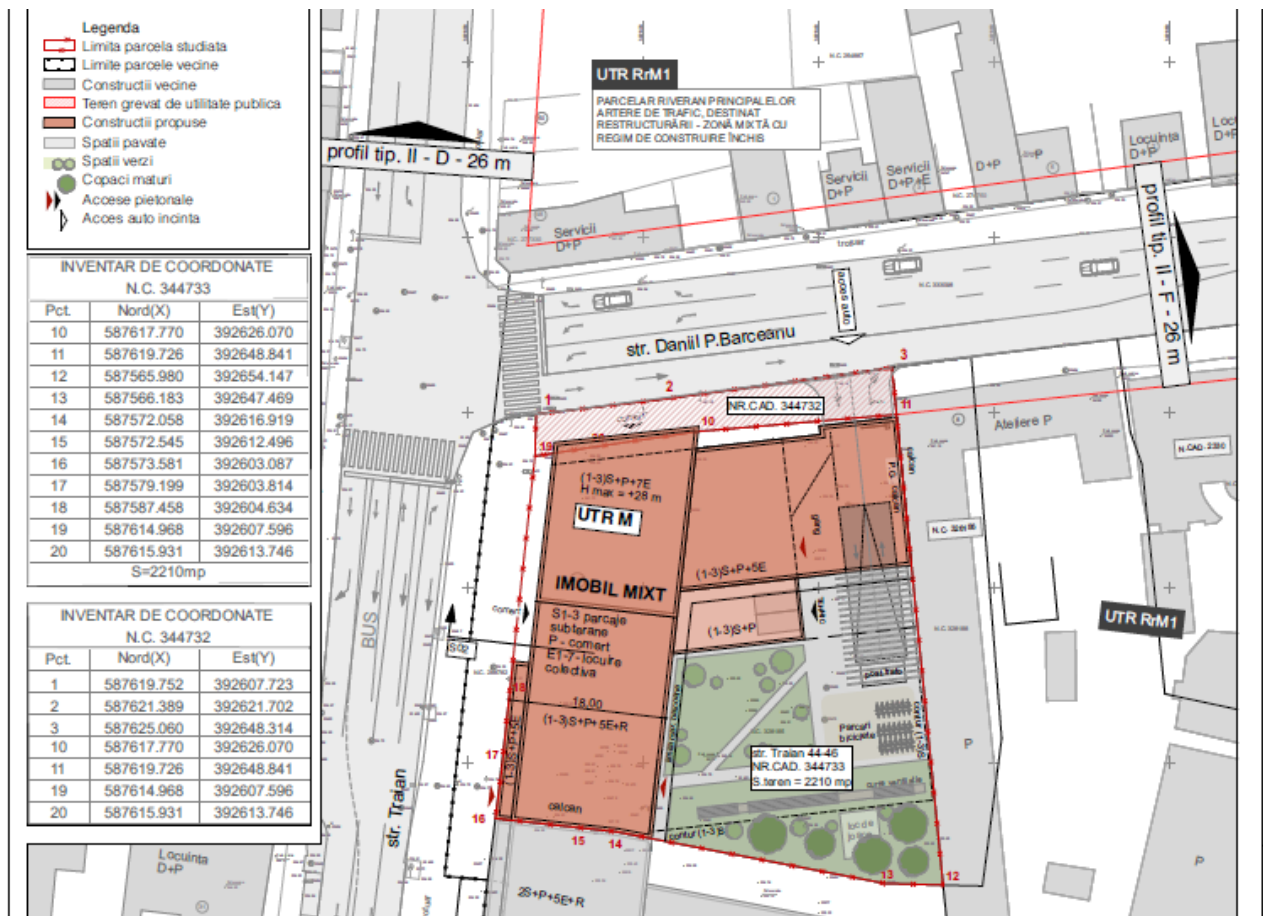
Plan de situatie întocmit de Atelier RVD
